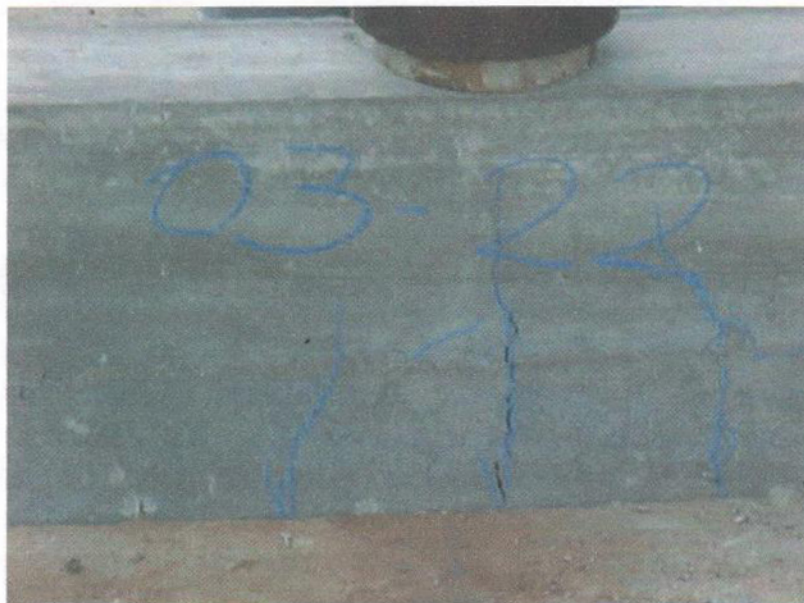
Ocorrência de fissuras durante o ensaio (Amostra 03 – concreto Fck 22Mpa).
